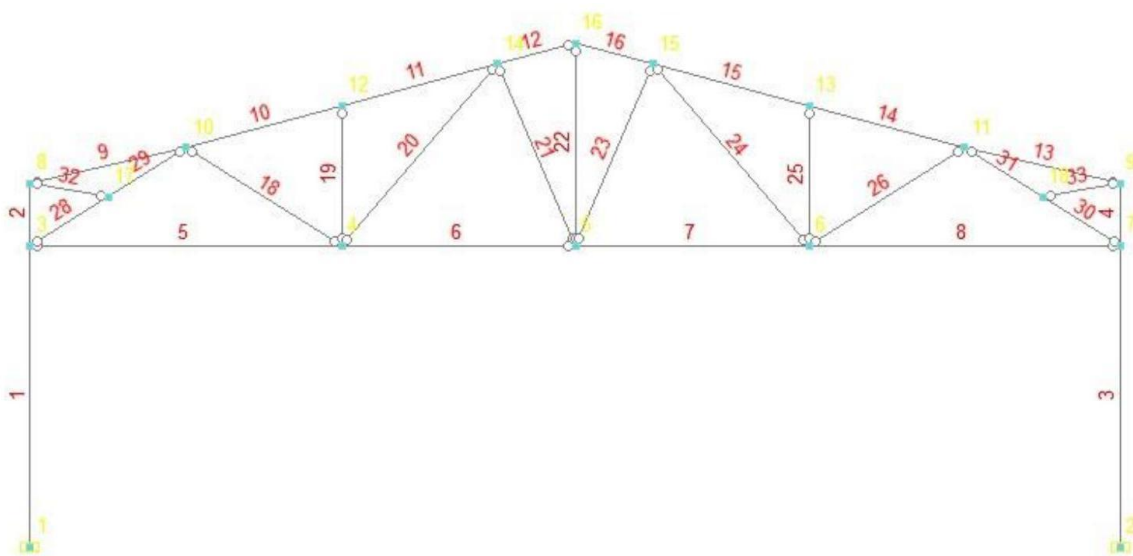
Розрахункова схема поперечного перерізу будівлі в осях 11–19
